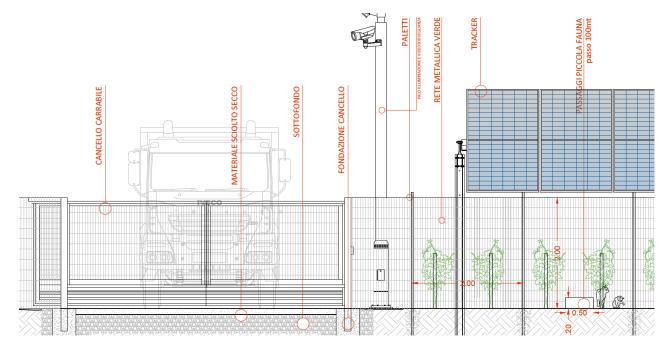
Particolare in prospetto recinzione (Rif. FV.ALC01.PD.F.02)
